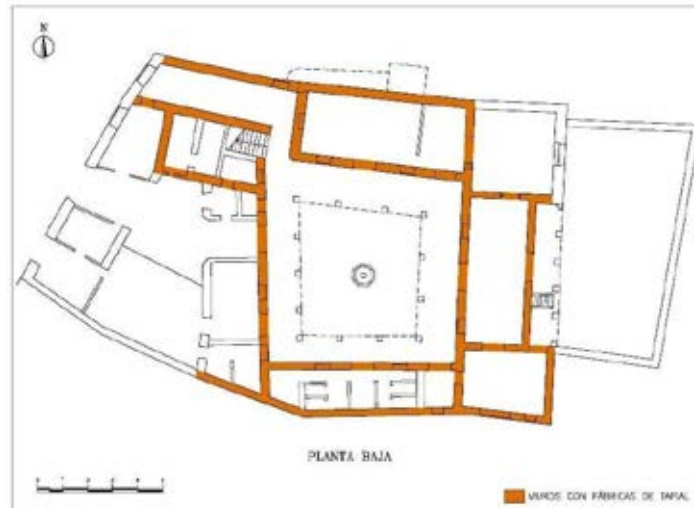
Casa de Calle San José 3. Planta baja. Muros constatados en tapial
